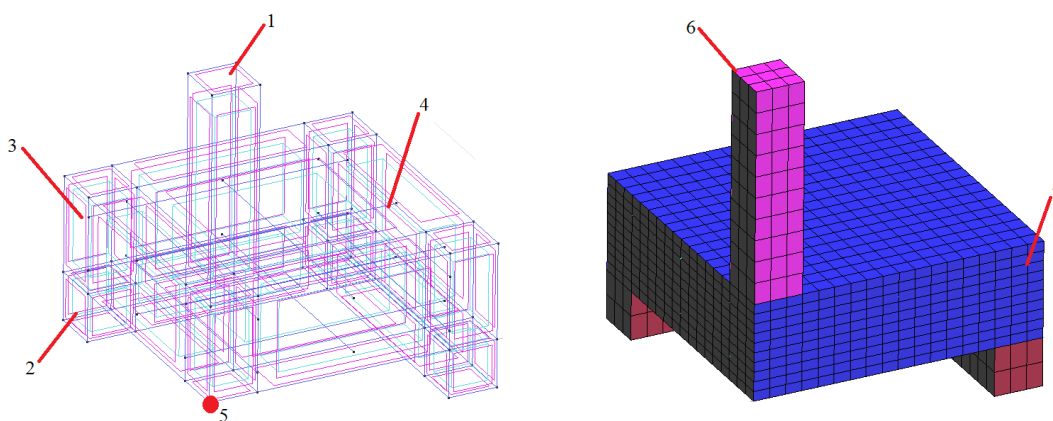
3D (слева) и КЭ (справа) модели для численных исследований с использованием ПК ATENA: 1 – колонна; 2 – опорная конструкция; 3 – плита перекрытия; 4 – арматурные стержни; 5 – точка мониторинга перемещений вдоль вертикальной оси; 6 – место приложения нагрузки; 7 – закрепление образца от смещения из плоскости симметрии
